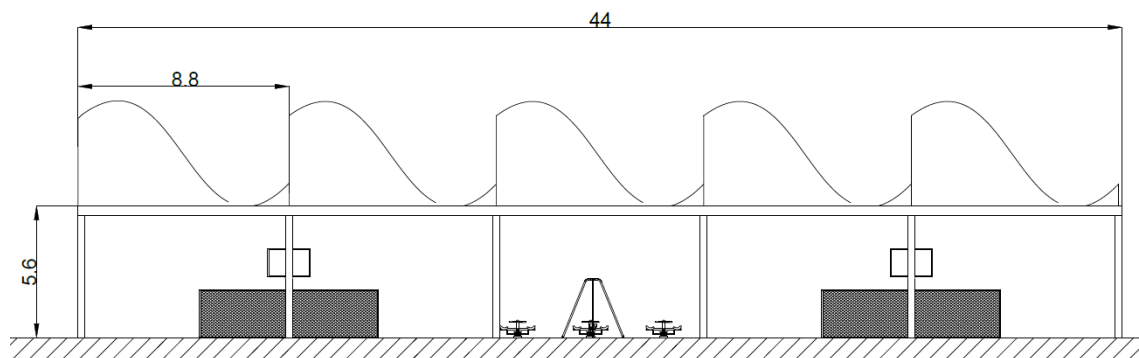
Sección Transversal bóveda propuesta Fuente: Elaboración propia
